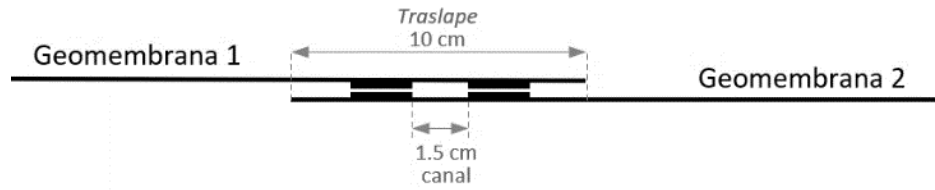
Longitud de traslape soldadura geomembrana
